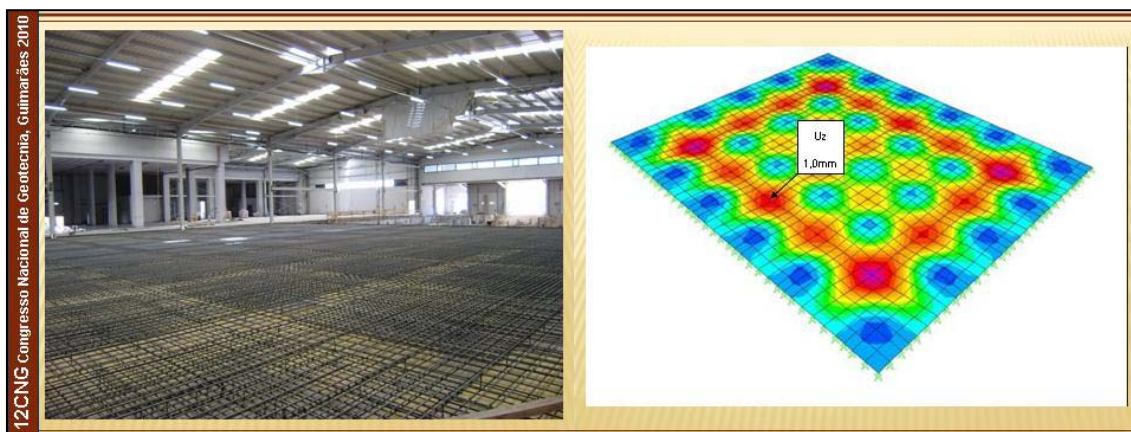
Vista dos trabalhos de cofragem e colocação de armaduras das lajes e pormenor de elementos técnicos contemplados no dimensionamento
